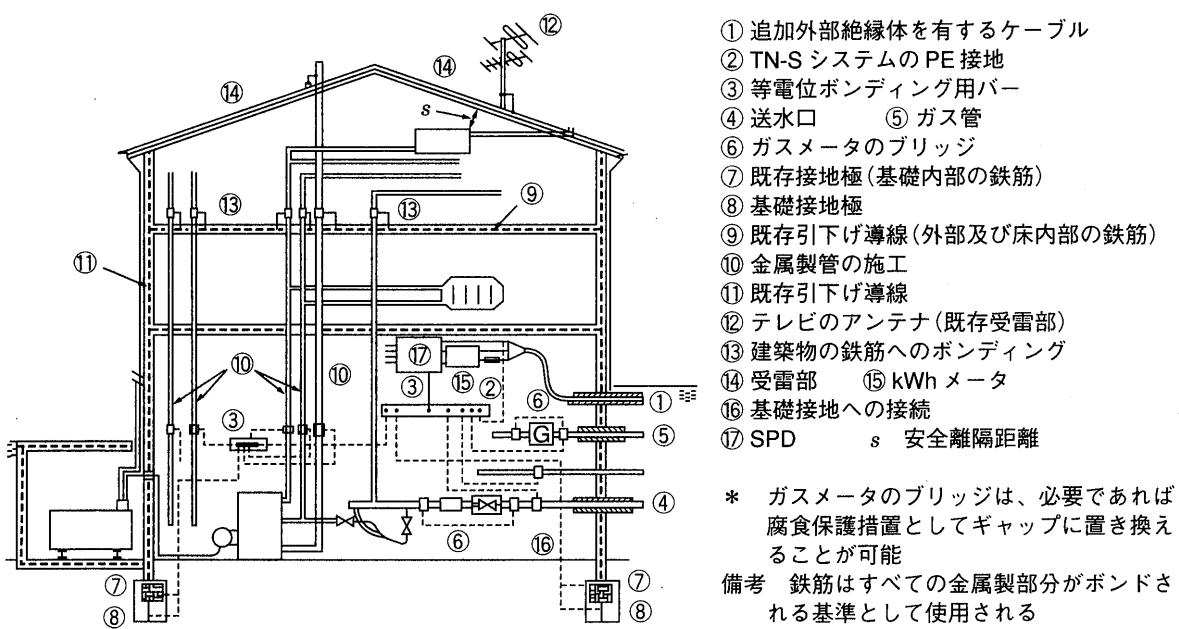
鉄筋コンクリート造建築物の内部LPS設置例
